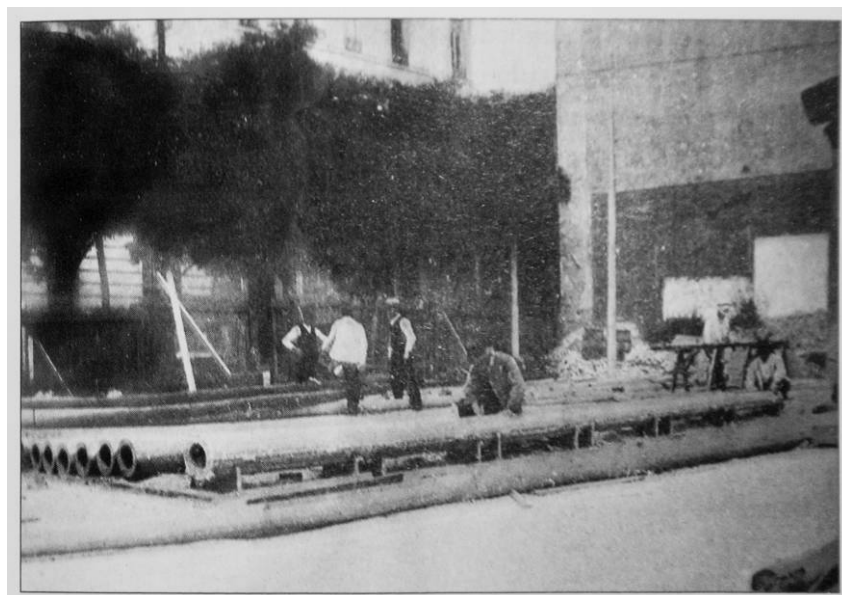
Construcción de postes de hormigón armado en la sociedad LBS, Madrid 1910.
